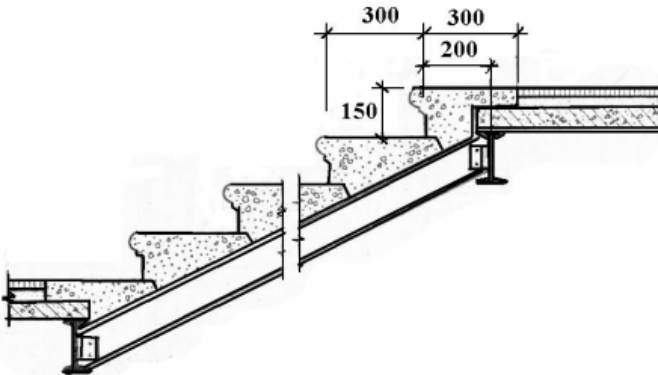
Конструктивне рішення дрібноелементних сходові (набірні залізобетонні щаблі укладені по сталевому косоуру, що спирається на двотаврову балку)
